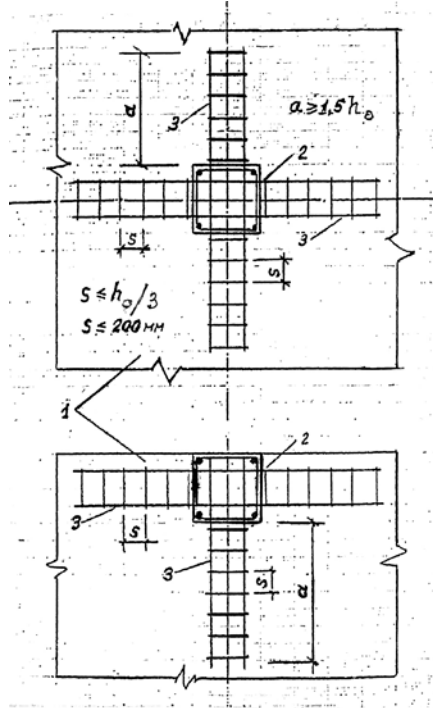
Поперечная арматура в зоне узла сопряжения плиты с колонной: 1 – плита; 2 – колонна; 3 – арматурные каркасы.
